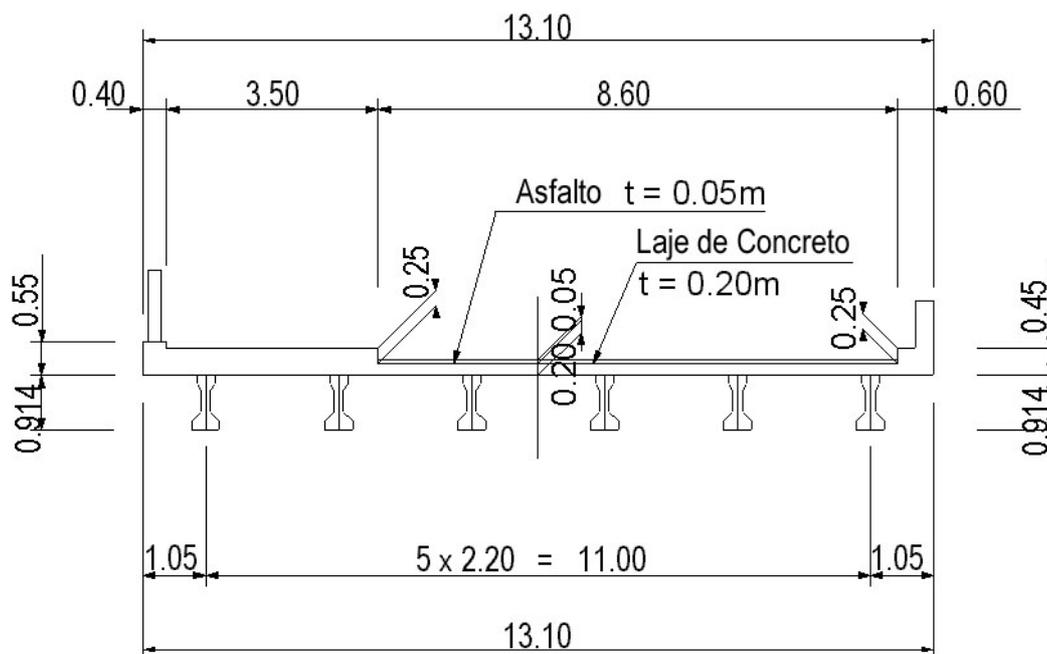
Proposta de Seção Transversal da Estrutura
